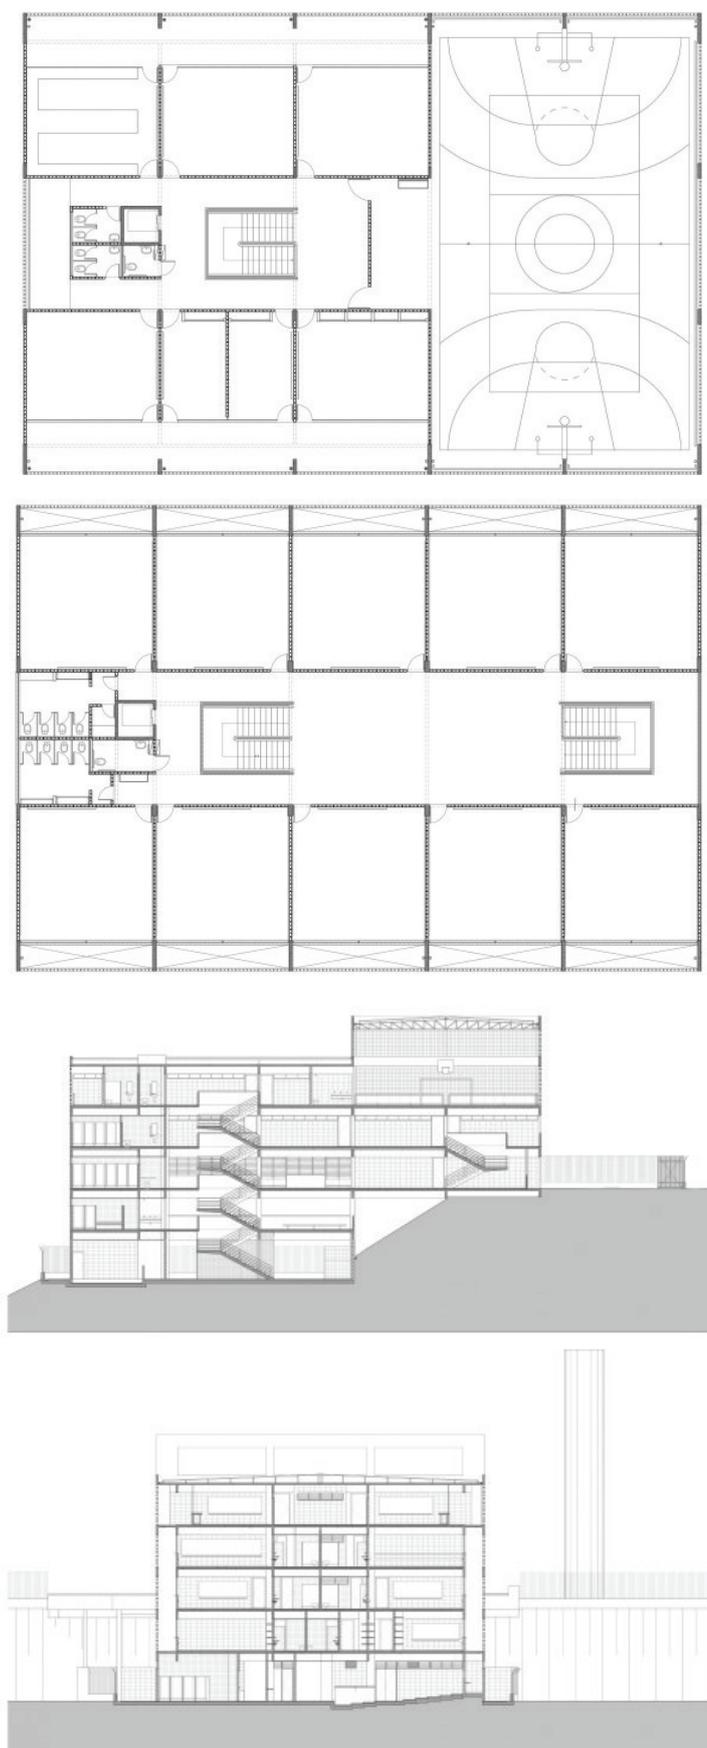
FDE - Escola Mário Lago em São Paulo. Planta térreo e pavimento-tipo e cortes longitudinal e transversal.
